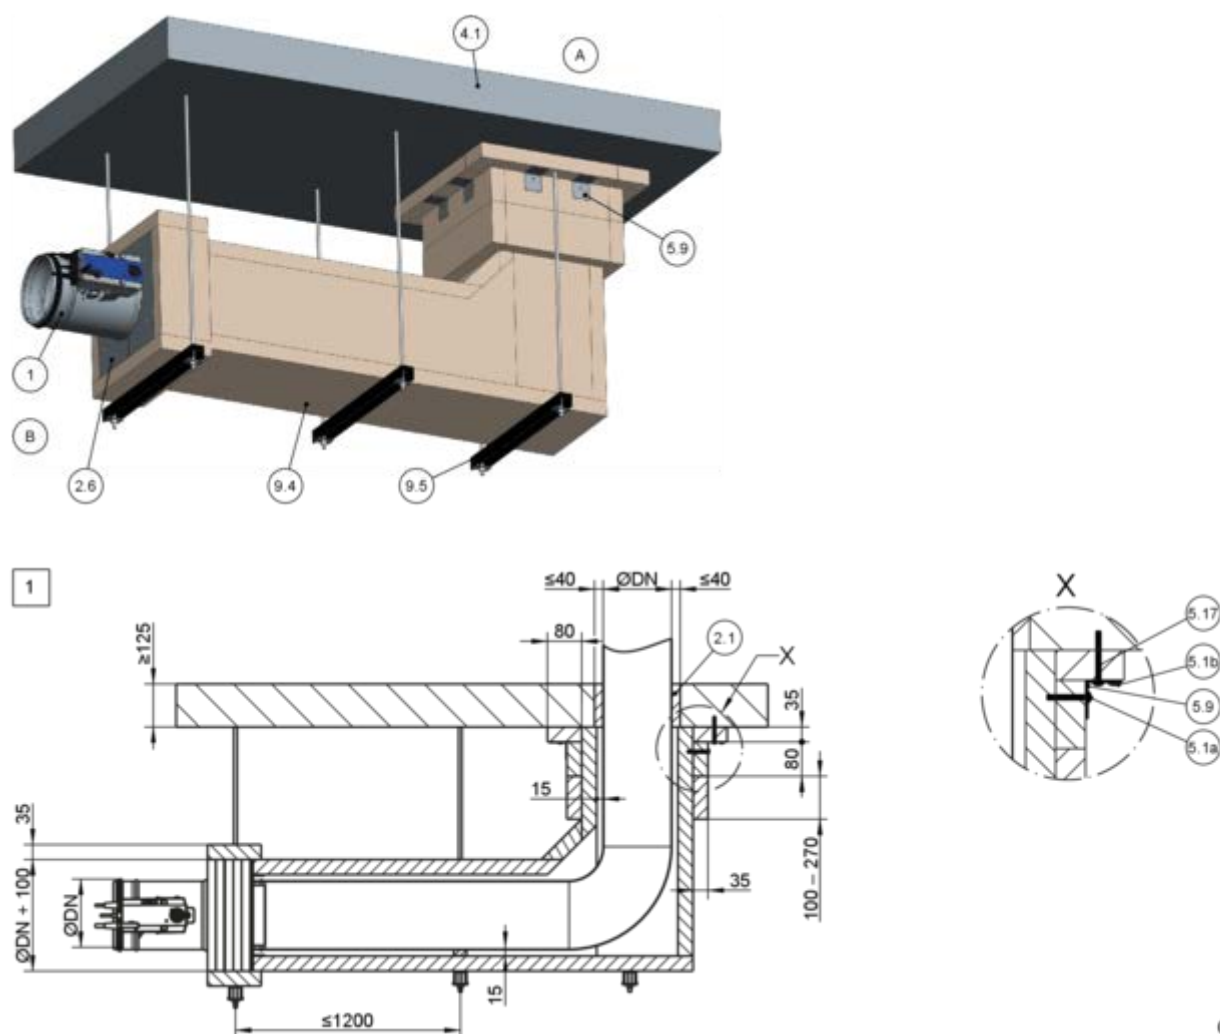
Torr installation utan murbruk i en massiv våningsavskiljning med installationskit WA2, illustration visar stående installation (gäller även nedhängd installation)
